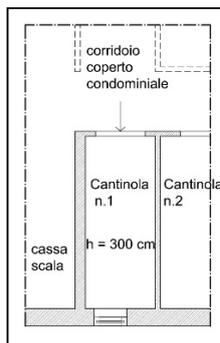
b\_Planimetria di stato attuale della cantina (n.1) di pertinenza dell'appartamento
